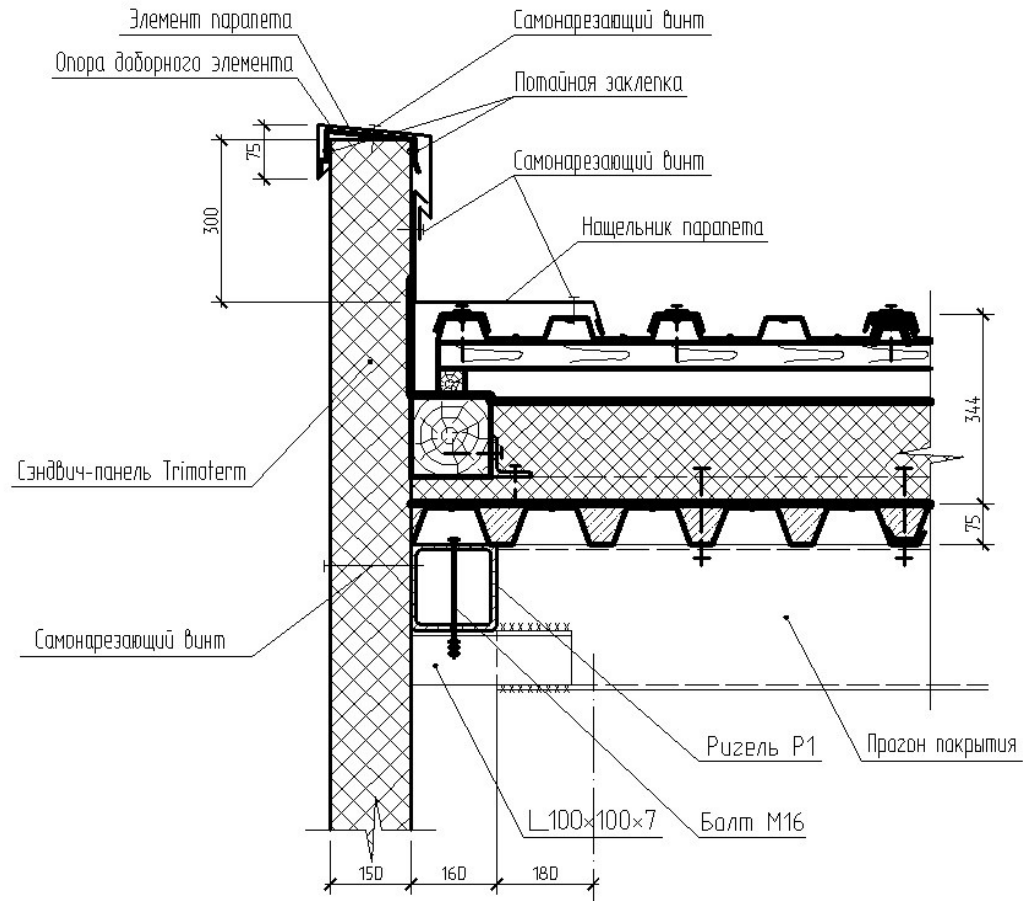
Конструкция узла примыкания стеновых панелей к кровле
